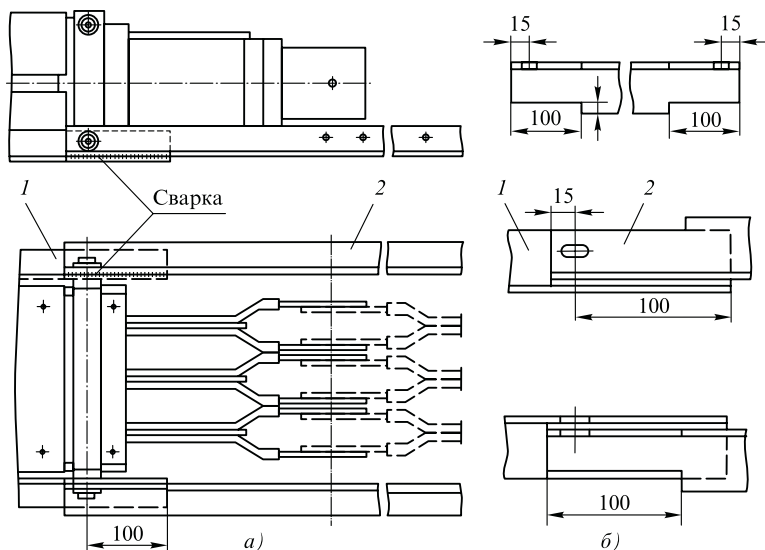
Схема подготовки опорных уголков шинопровода для сварки (а) и деталь (б) для вырезки полок опорного уголка и соединительной перемычки:
